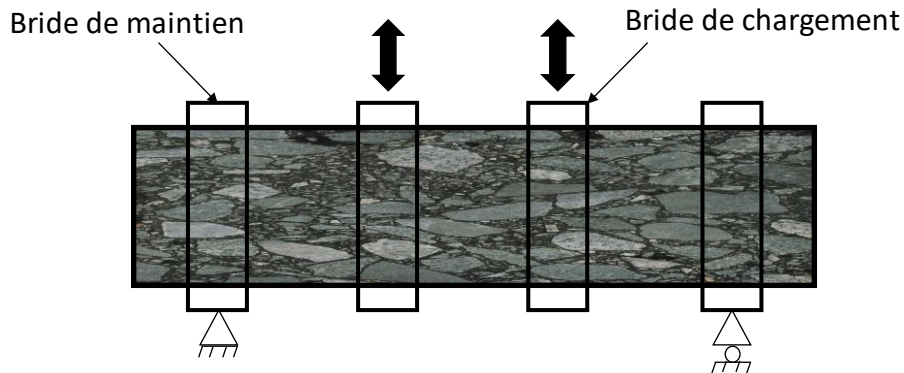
Principe de l'essai de flexion 4-points (NF EN 12697-24, 2018)
